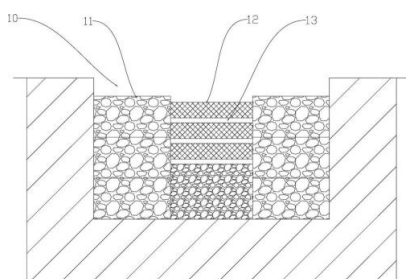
本施工方法的水闸上游和下游的土石围堰截面示意图
